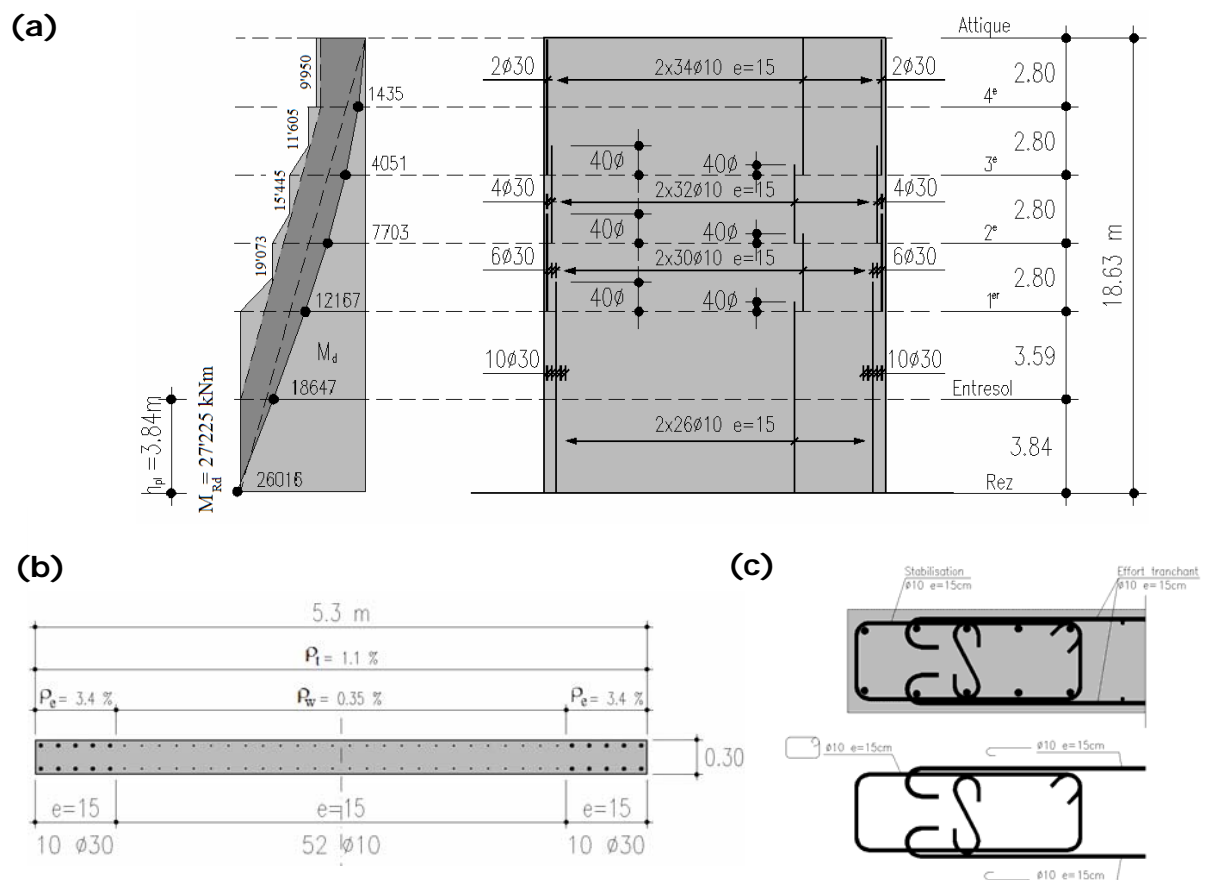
Konkrete Tragwand aus [9]: (a) Biegebeanspruchung und Bewehrungslayout; (b) Konzentration der Bewehrung in den Randbereichen; (c) Verbügelung.
